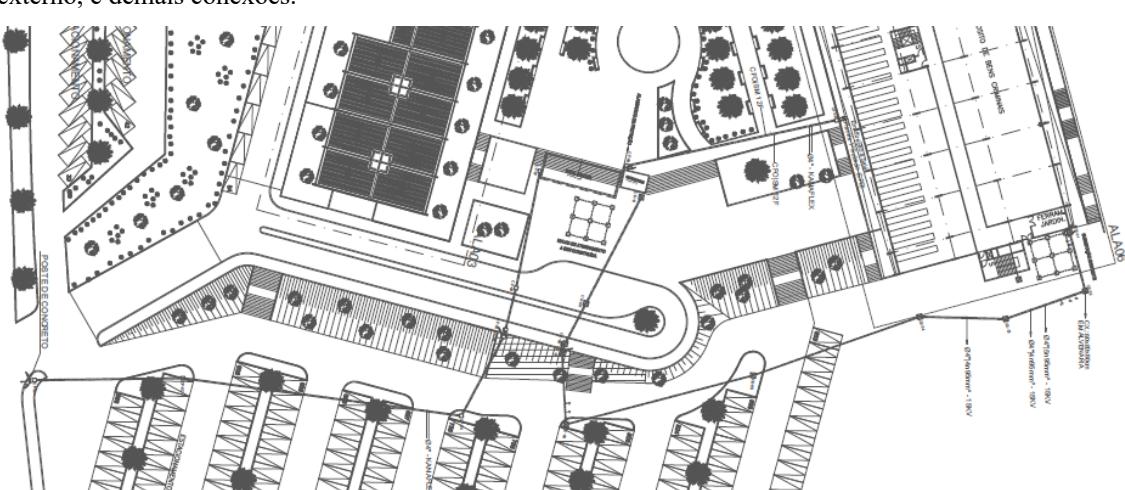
Planta de implantação com a indicação da localização do DC e dos encaminhamentos externos lógicos e elétricos – Maiores detalhes vide planta presente no Anexo II-C.
